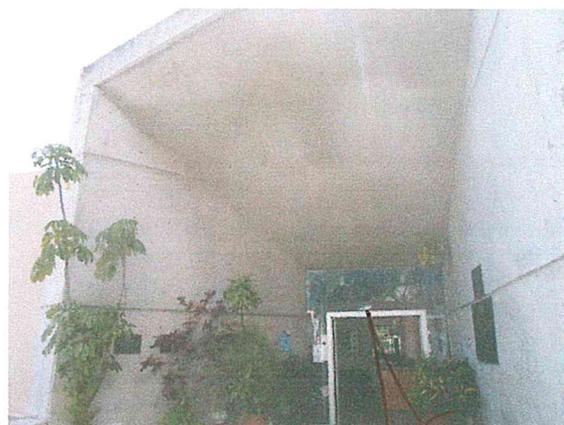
y 2. Fachada principal y acceso a la Casa Hogar, hecha a base de concreto armado, sin afectaciones estructurales.
